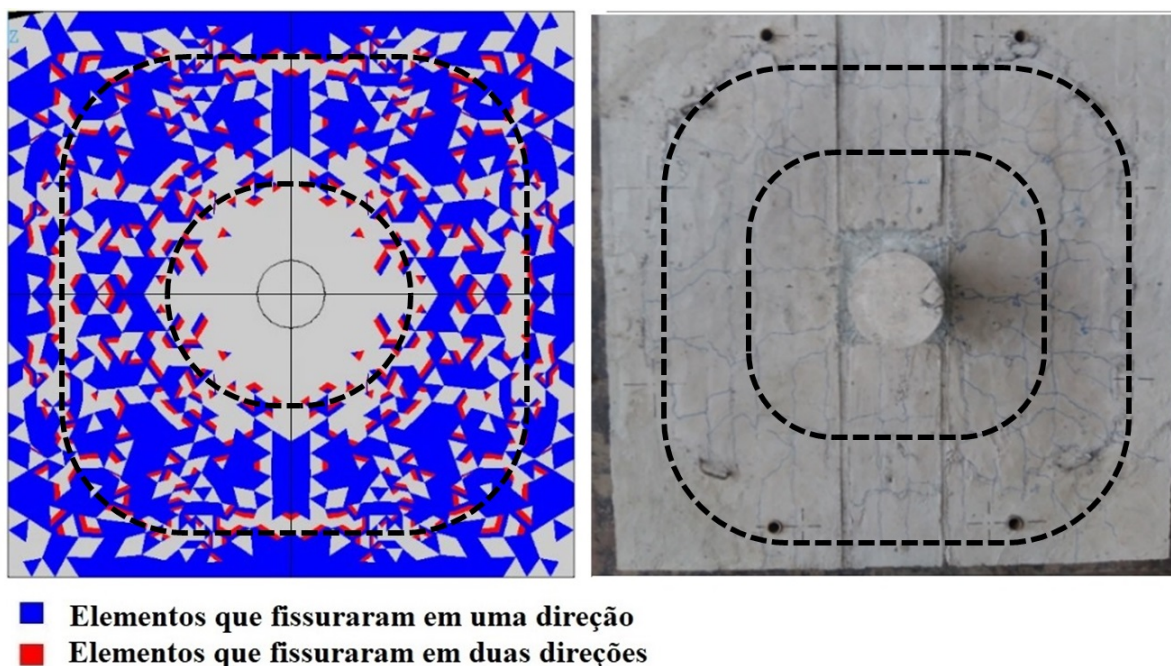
Mapa de fissuração na superfície superior da laje BD-A05 após o ensaio (fonte: Autor)
